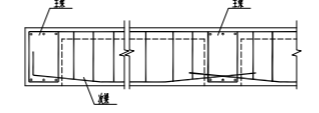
主次梁等高时, 次梁纵向钢筋应置于主梁纵向钢筋之上
